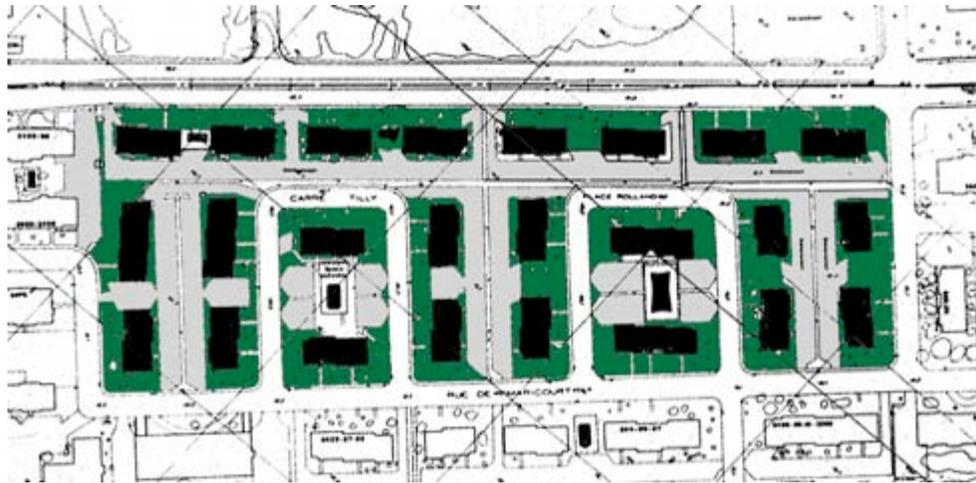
Plan d'implantation existant de l'ensemble, avant les interventions proposées.
